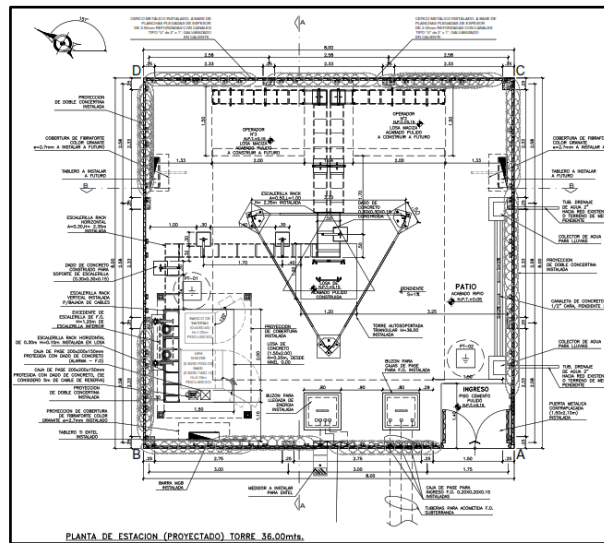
Plano de Planta Model Estación Base Celular Tipo Greenfield
